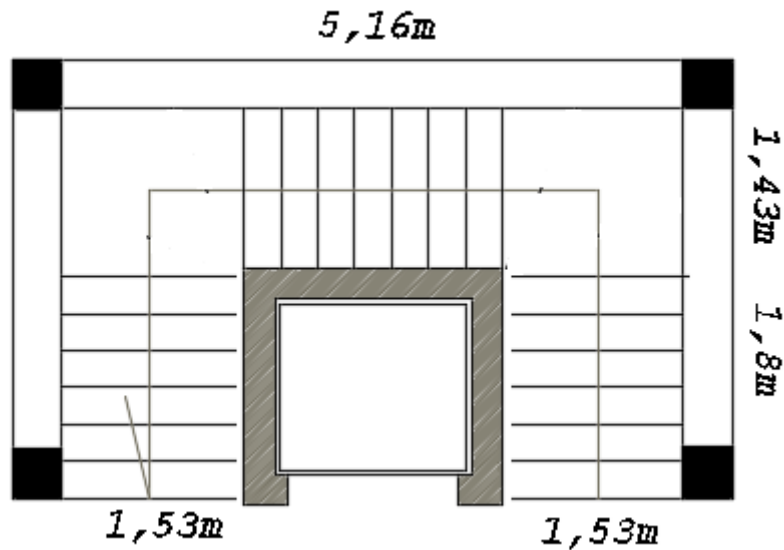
Vue en plan de l'escalier à 3 volées.
